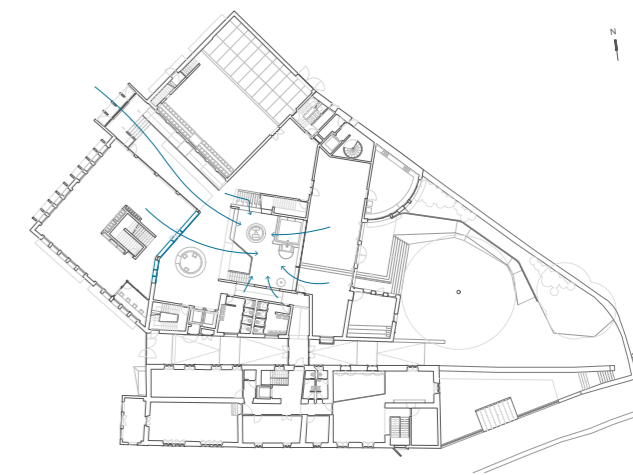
Planta do piso 1 (setas de relações com o espaço central).
